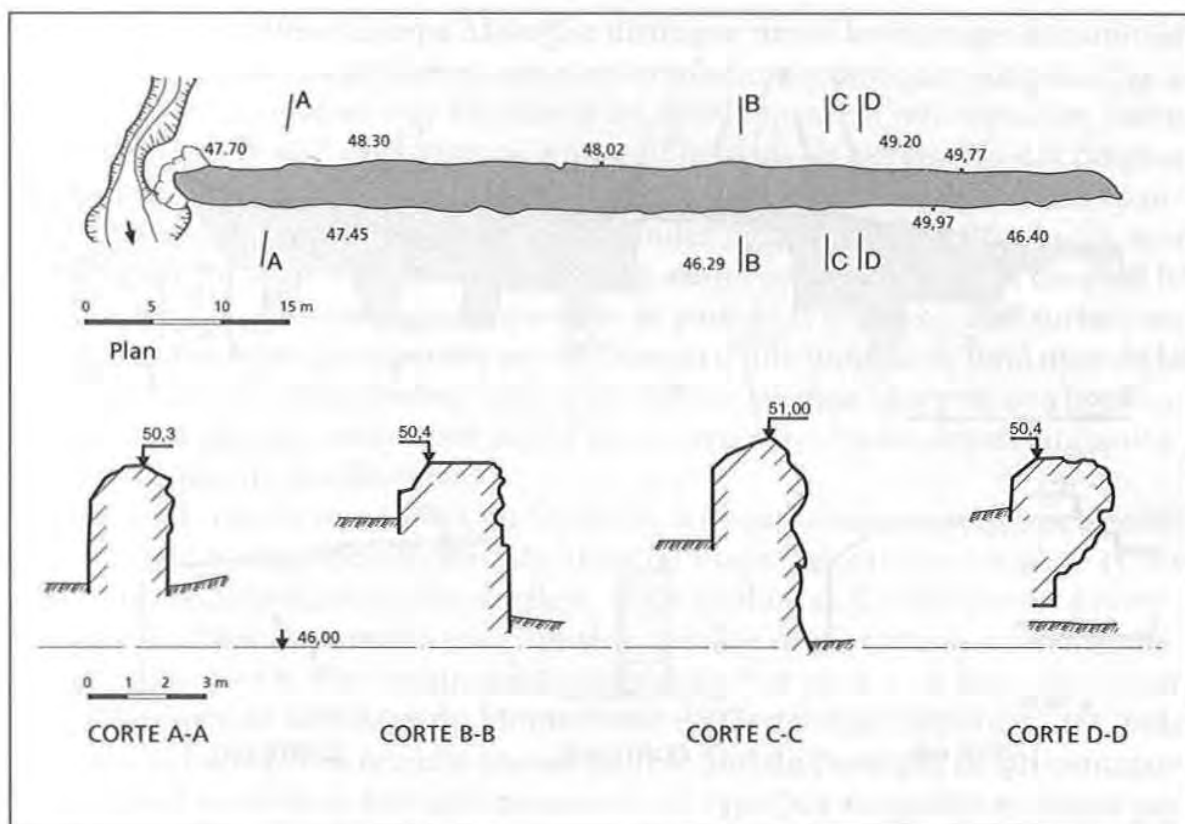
Barrage de Pisões (Beja). Plan et coupes transversales. Référence altimétrique arbitraire.
